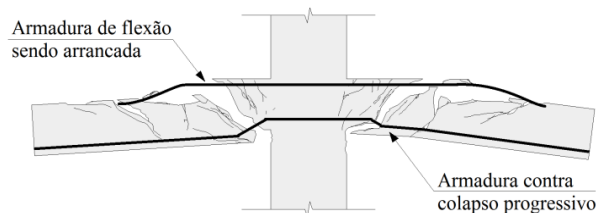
Armadura contra colapso progressivo [adaptado – Ferreira (2010)]
